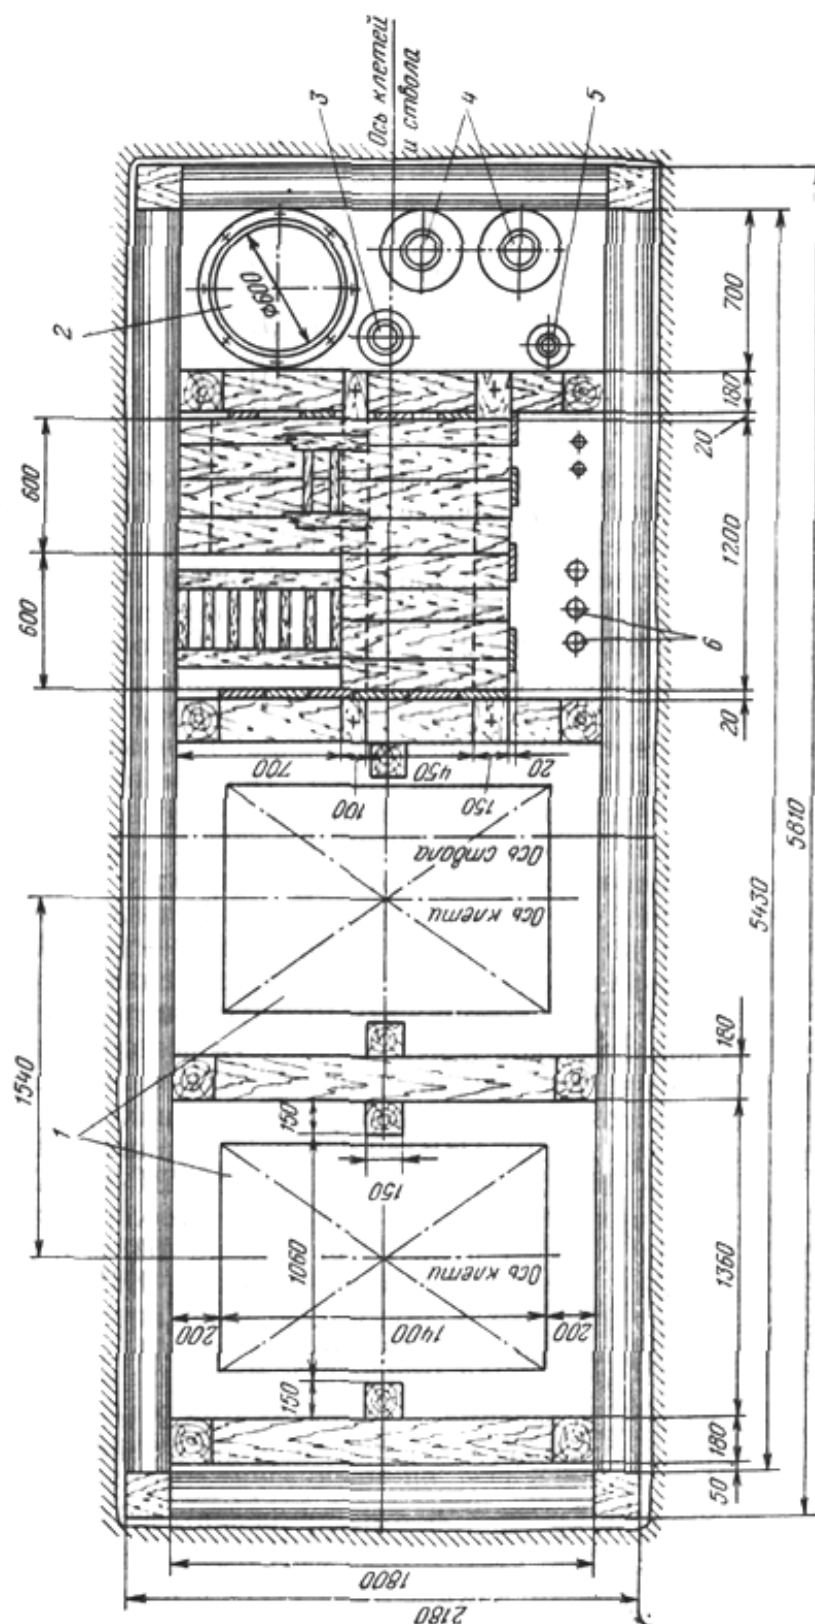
Типовое прямоугольное сечение ствола разведочной шахты площадью 14,2 м<sup>2</sup>: 1 – шахтные клетки; 2 – вентиляционный трубопровод; 3 – трубопровод для подачи сжатого воздуха; 4 – трубы для водоотлива; 5 – трубопровод водоснабжения; 6 – электрические кабели
